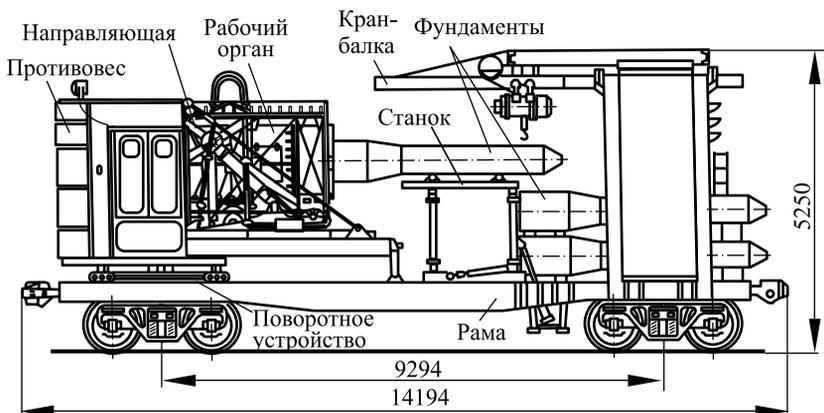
Агрегат вибропогружения свай (вибропогружатель) АВСЭ-М
